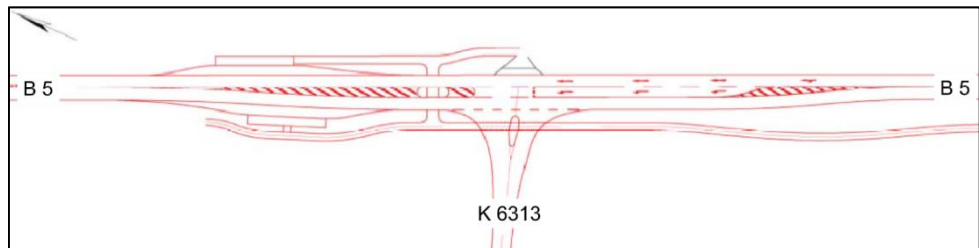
Planung des KP 1 (LANDESBETRIEB STRAßENWESEN BRANDENBURG)
